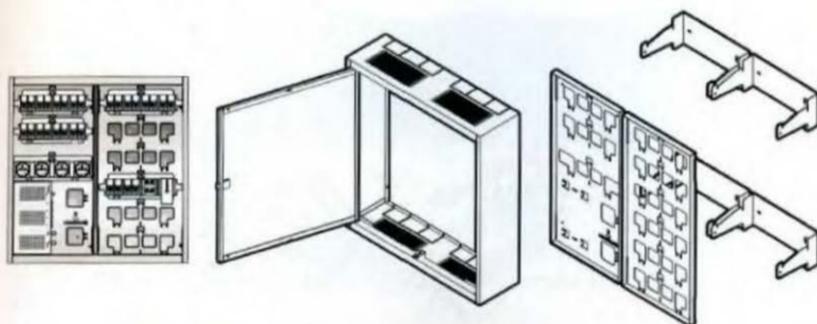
BRU mixte encastré platine double, largeur 600 mm
